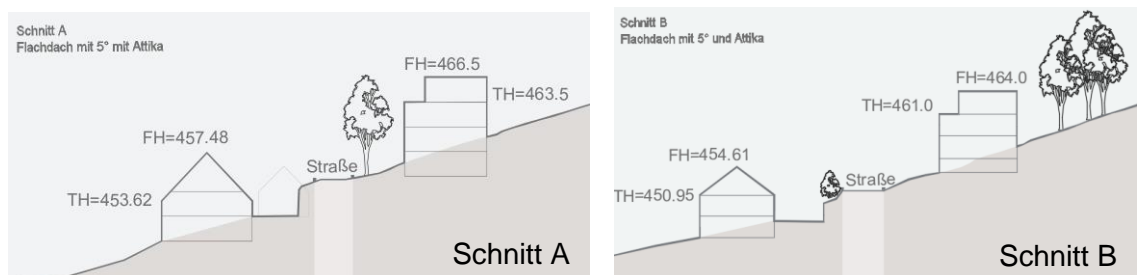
Schematische Darstellung einer möglichen Bebauung mit einem Attika-Geschoss und einem Flachdach (eigene Darstellung)
